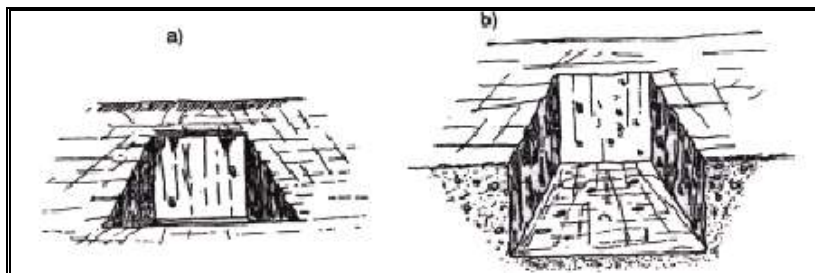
Cepa común: a) vista superior; y b) corte transversal
